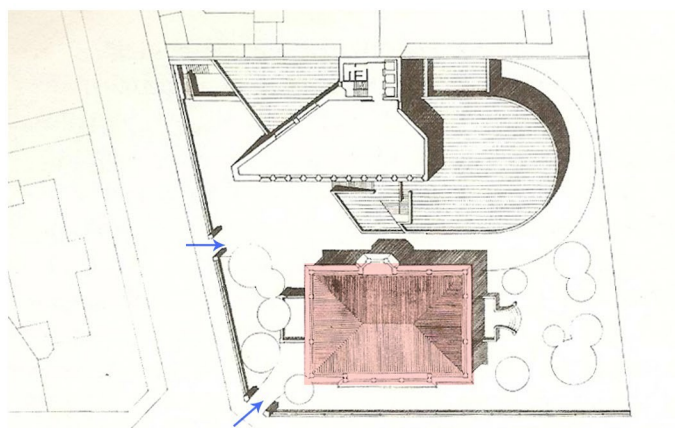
Planta del conjunto modificada por el alumno, en rojo el palacete preexistente y en azul las entradas al edificio y al palacete
